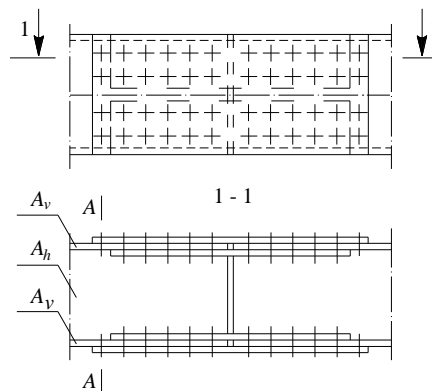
Расположение проверяемого на выносливость расчетного сечения А – А по основному металлу в сечении брутто по первому ряду высокопрочных болтов в креплении к узлу или в стыке двухстенчатых элементов
